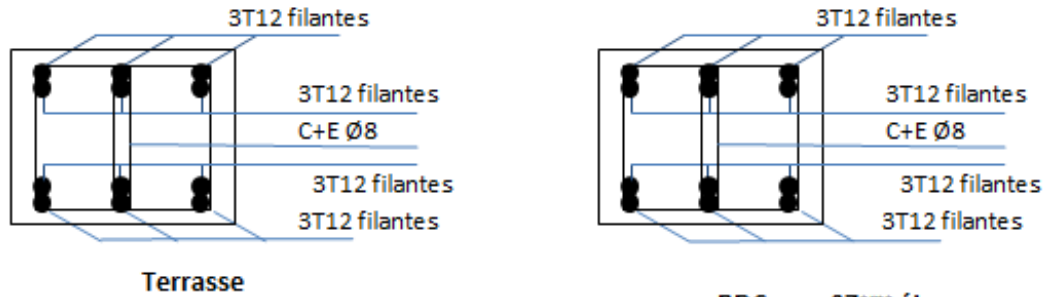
dessin de ferrailage des sections des poutres principales.
